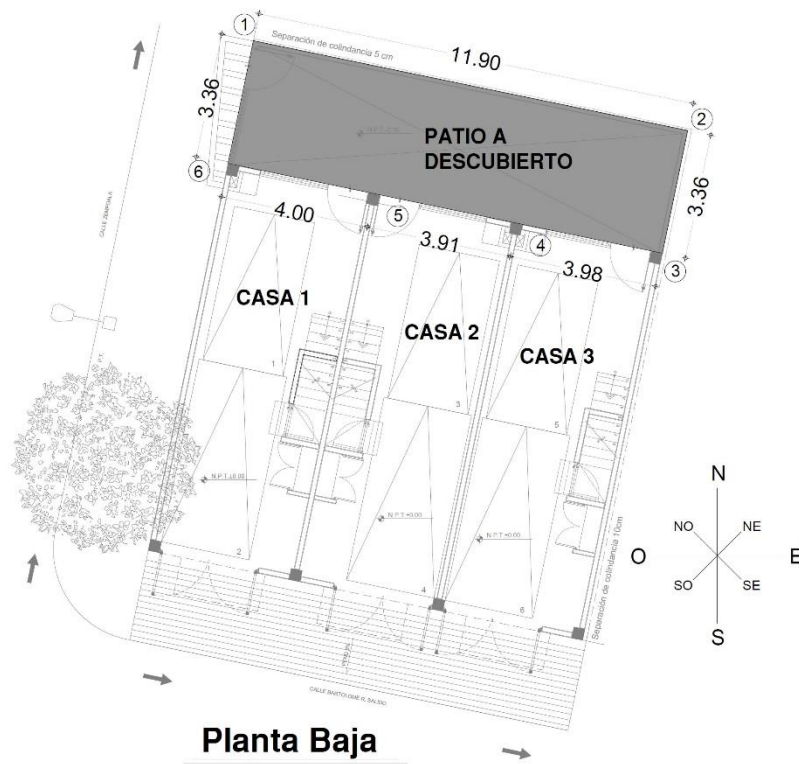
Esquema arquitectónico, Planta Baja, patio a descubierto.
